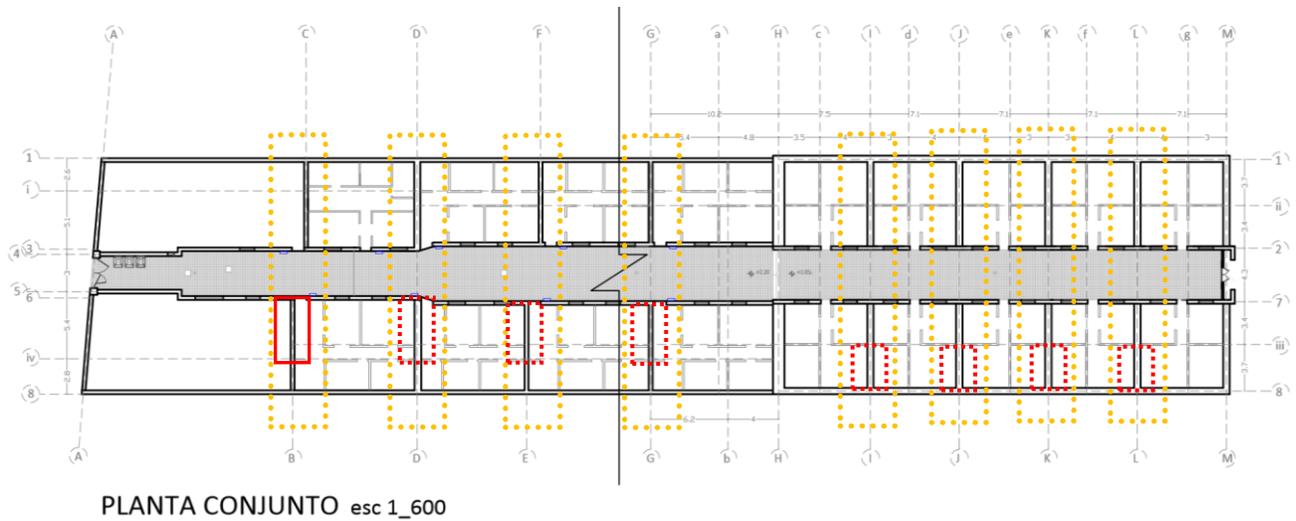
Plano de conjunto intervenido donde se indican en color rojo los muros más propensos.
